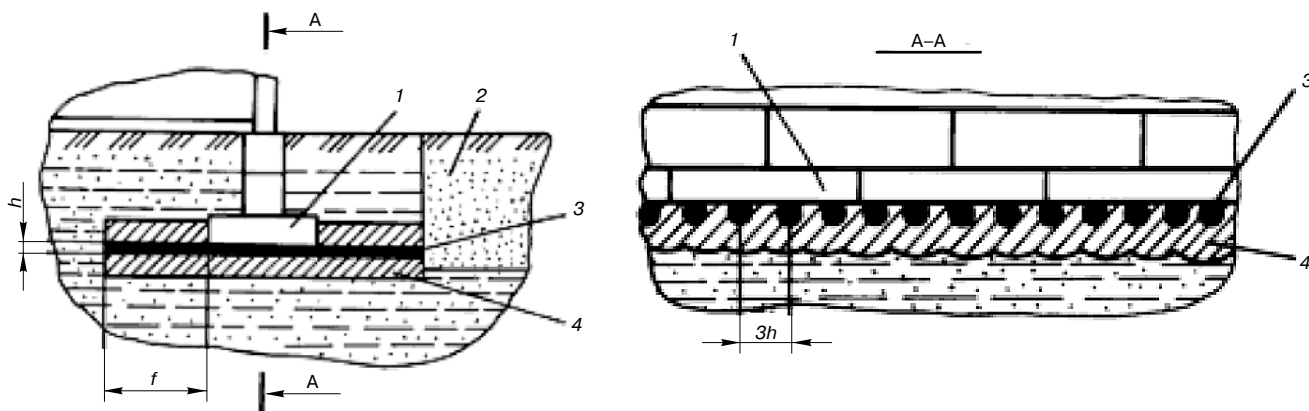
Способ усиления основания ленточных фундаментов с помощью создания под подошвой ГИК: 1 – фундамент; 2 – технологический приямок; 3 – геоимплантат; 4 – зона уплотненного грунта
